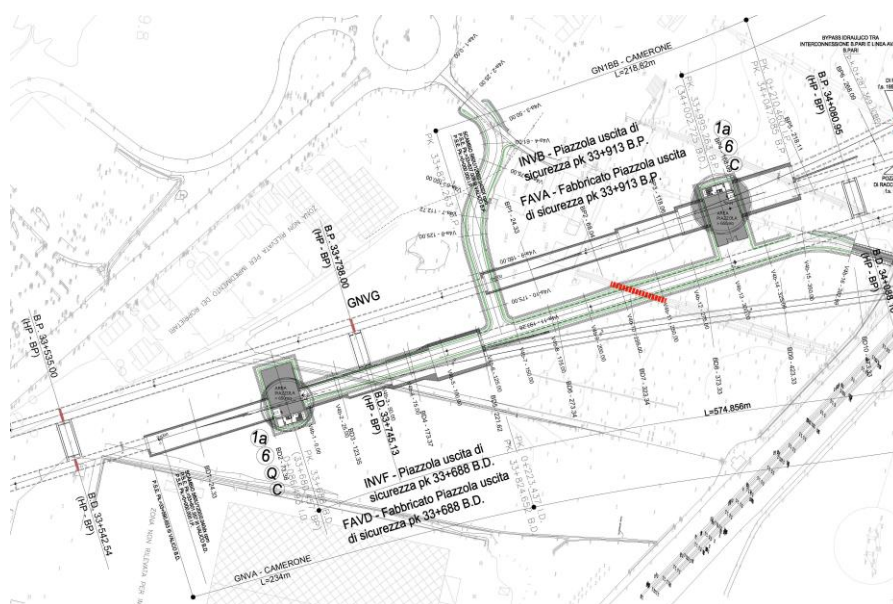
Stralcio planimetrico della zona dei cameroni e pozzi di entrambi i binari dell'Interconnessione
